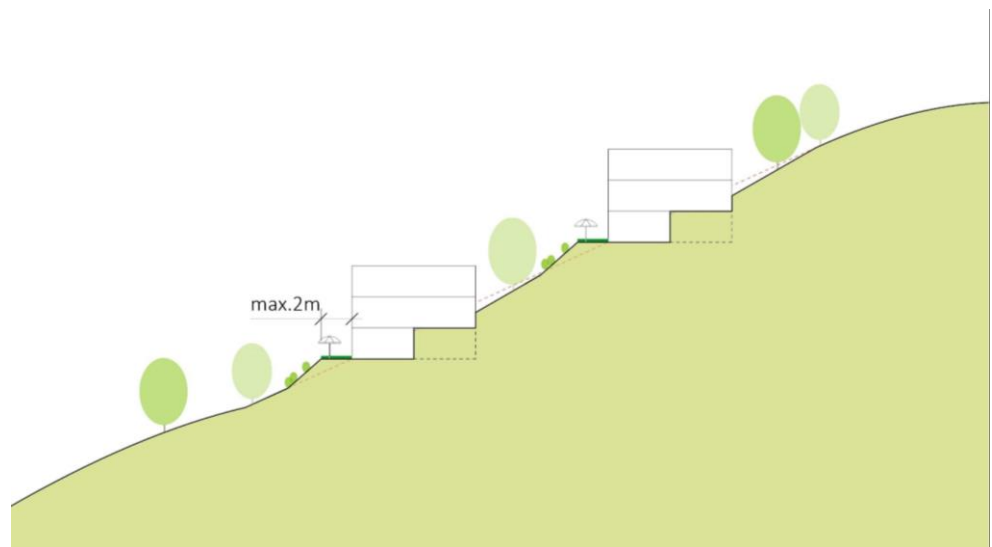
minimale Terrainveränderung ermöglicht qualitätsvolle Aussenbereiche
